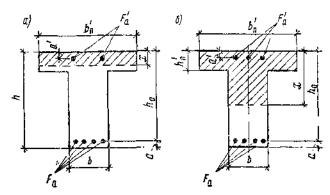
Форма сжатой зоны в сечении изгибаемого железобетонного элемента с пслкой в сжатой зоне а — при расположении границы сжатой зоны в полке; 6 — то же, в ребое
